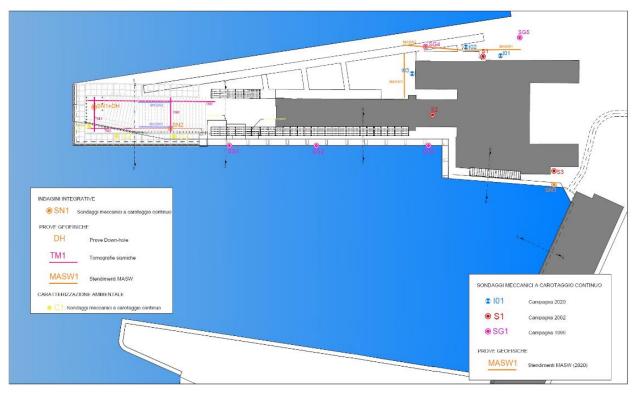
Planimetria delle indagini eseguite su Ponte dei Mille
